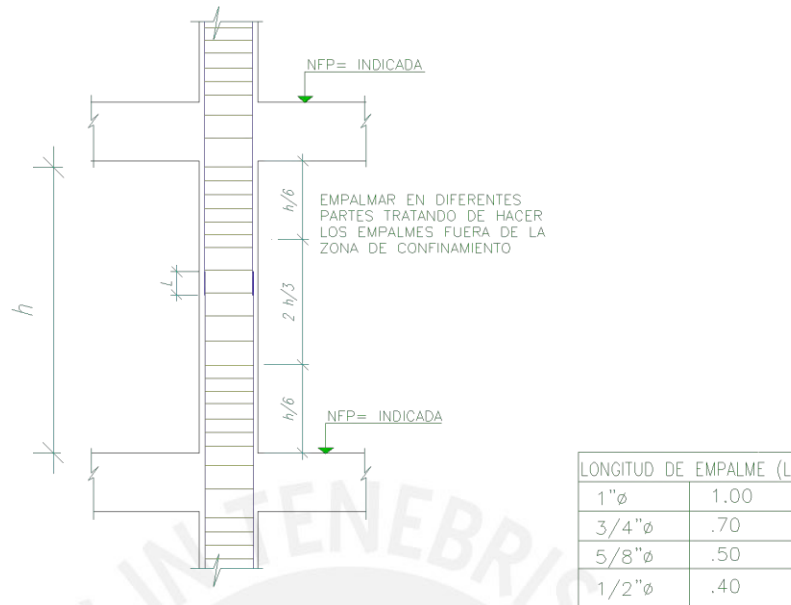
EMPALMES EN COLUMNAS EN ZONAS DE REFUERZOS BAJOS.
